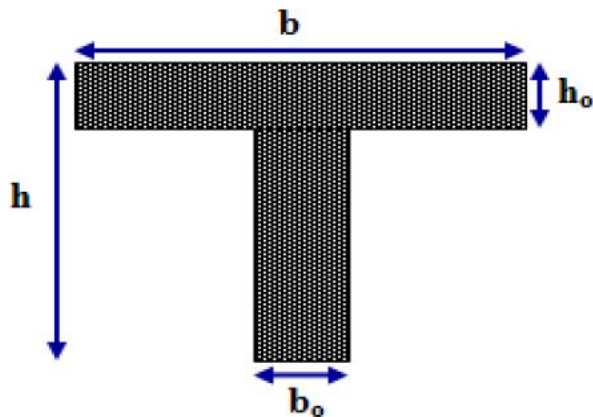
Coupe transversale d'une poutrelle
